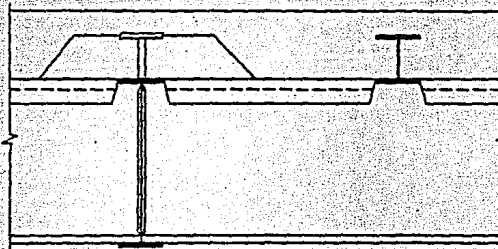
CONDICION DE APOYO SEMEJANTE A LA ANTERIOR.
